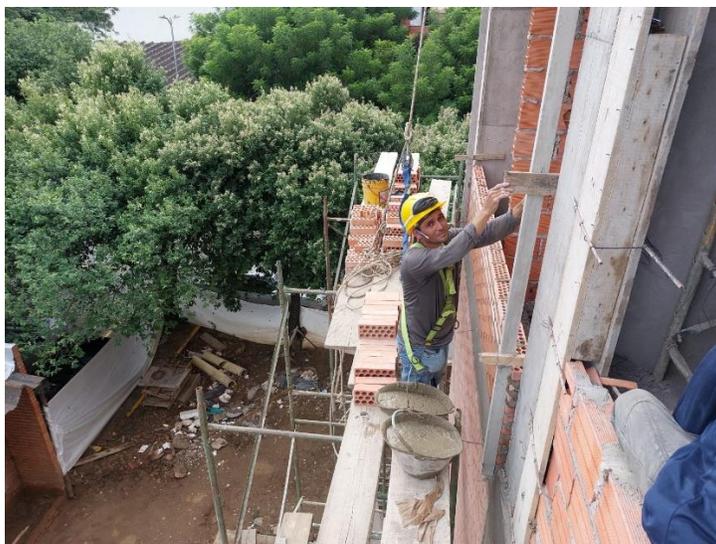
Realización de alzado de muro en ladrillo a la vista en fachada
